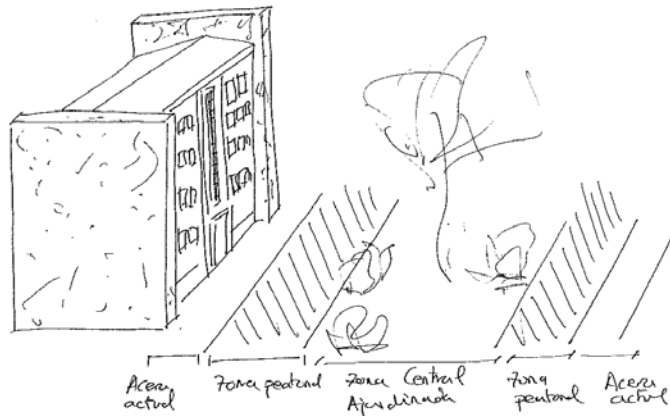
croquis a mano alzada de la zona central del barrio. Fuente: autor.
